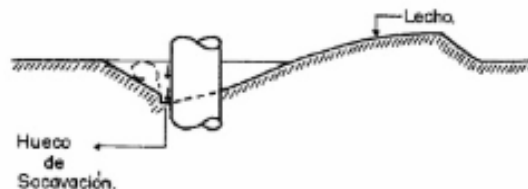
Croquis sección transversal foso socavación generado alrededor de la pila.<sup>47</sup>
